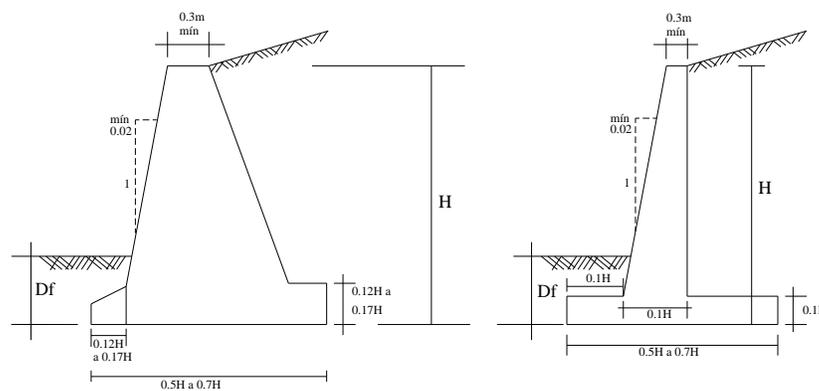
Geometría y predimensionamiento de la sección transversal de un muro
